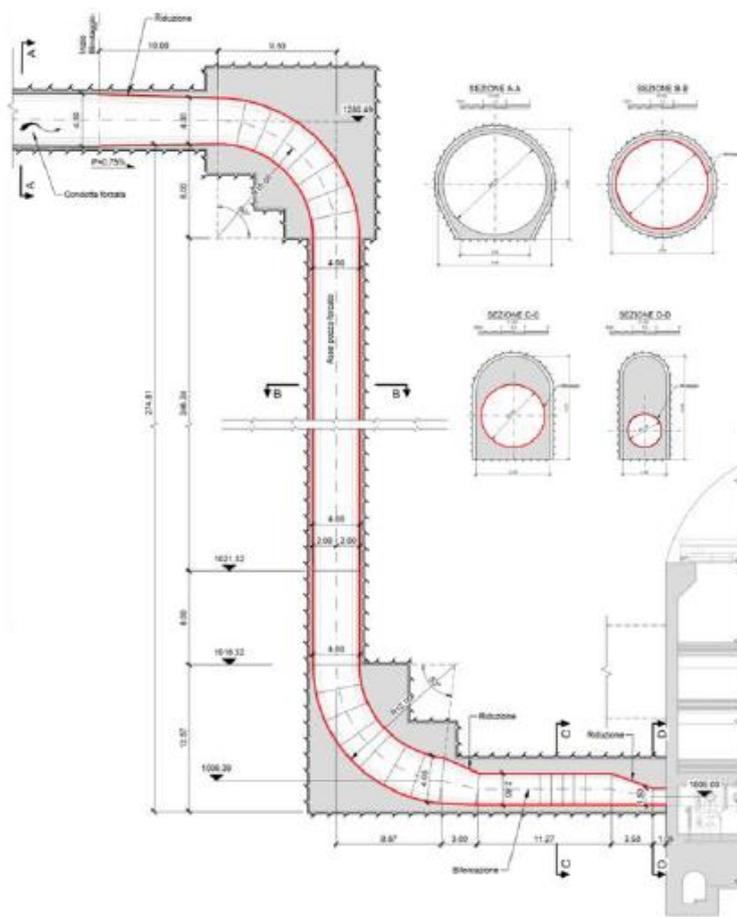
Nuovo pozzo forzato – profilo e sezioni
